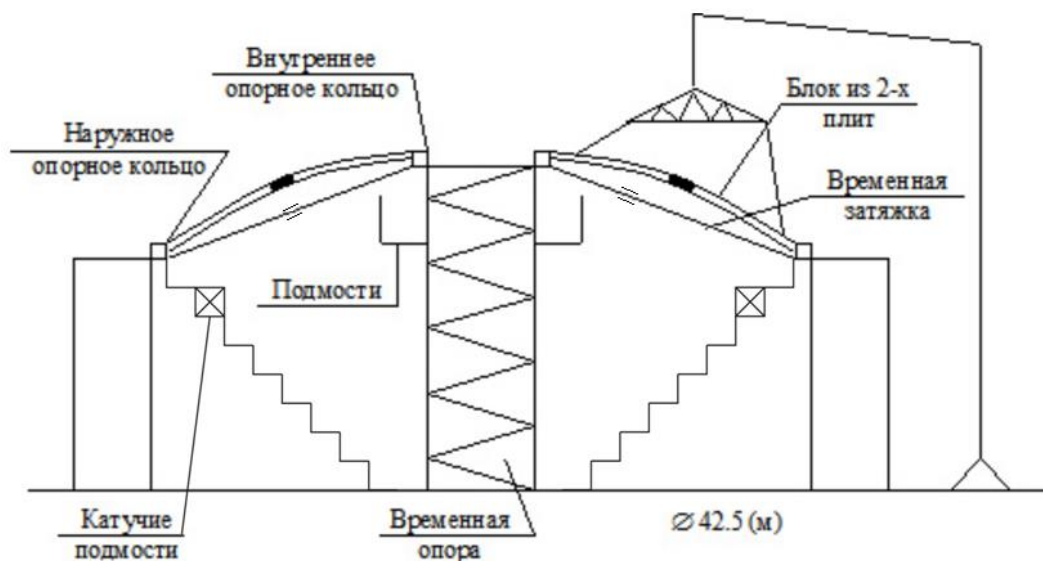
Монтаж куполов блоками из плит на всю высоту
